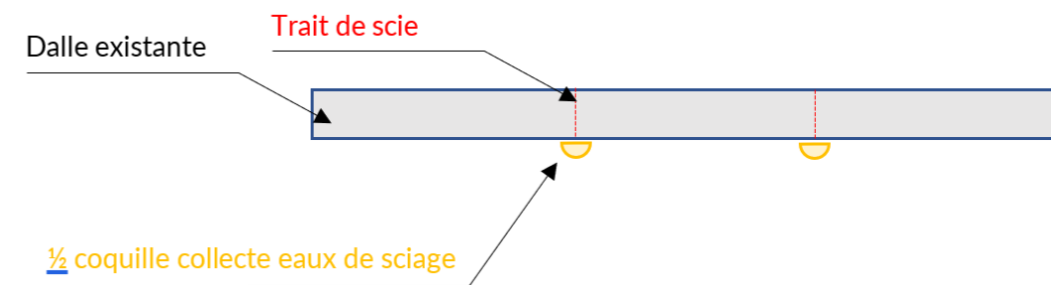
coupe transversale de la structure de protection phase travaux – Variante 2
